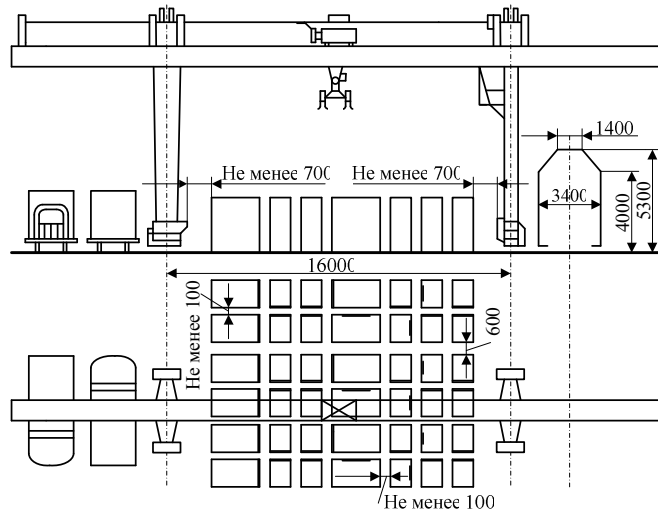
Схема механизированной перегрузки среднетоннажных контейнеров с использованием двухконсольного козлового крана
